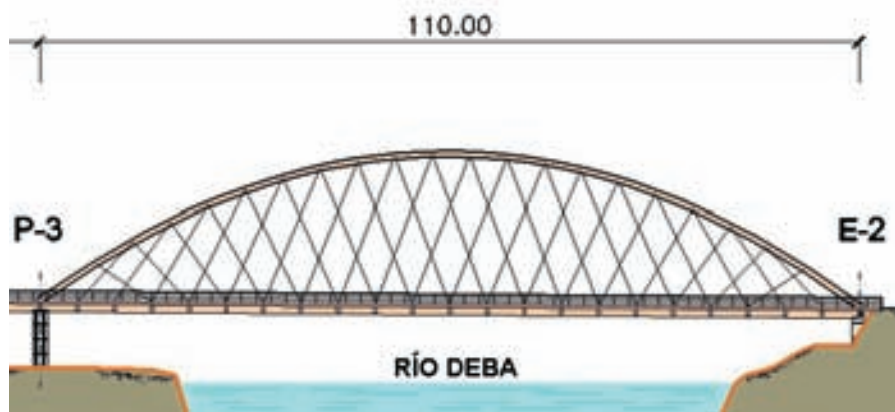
Alzado del puente arco. Esquema de malla tipo Network con anclajes cada 5 m
